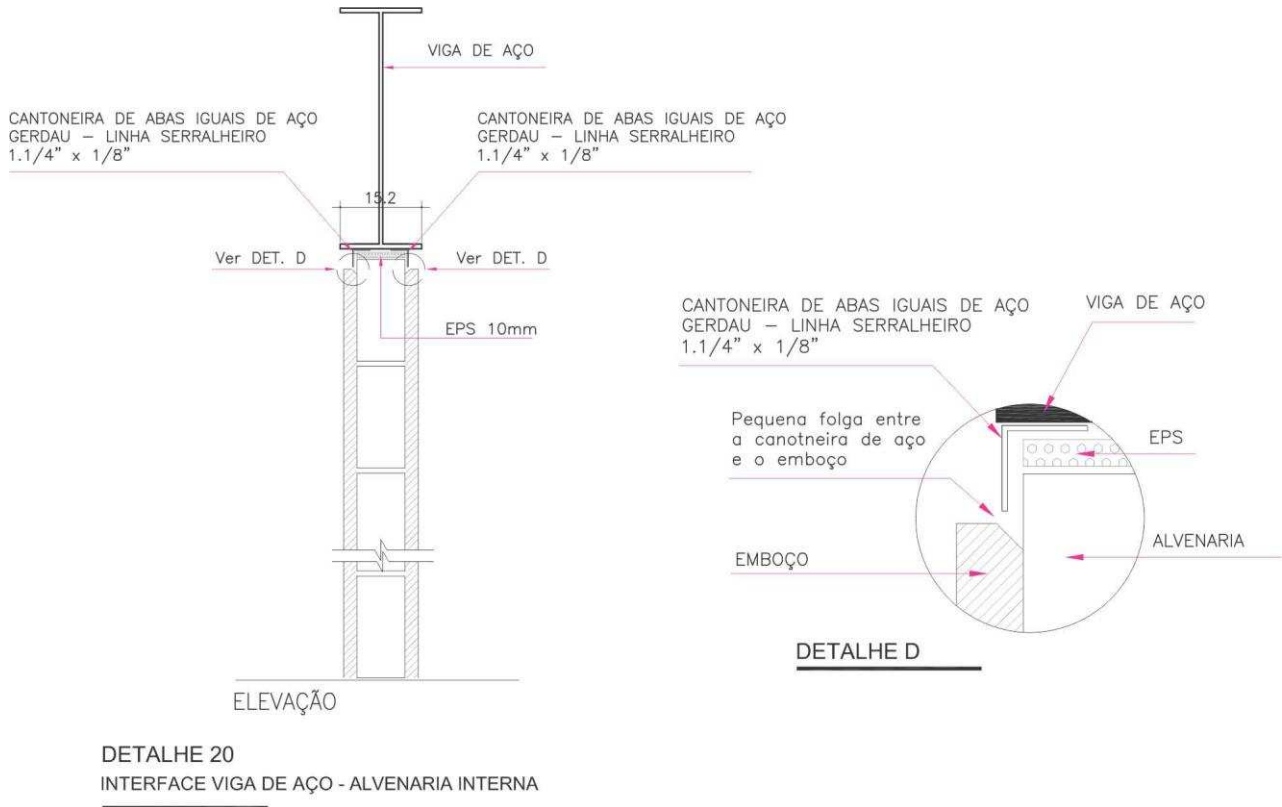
Detalhe do projeto de alvenaria da IPV, com o sistema de encaixe com cantoneiras e EPS na interface da mesa inferior da viga com a alvenaria.
